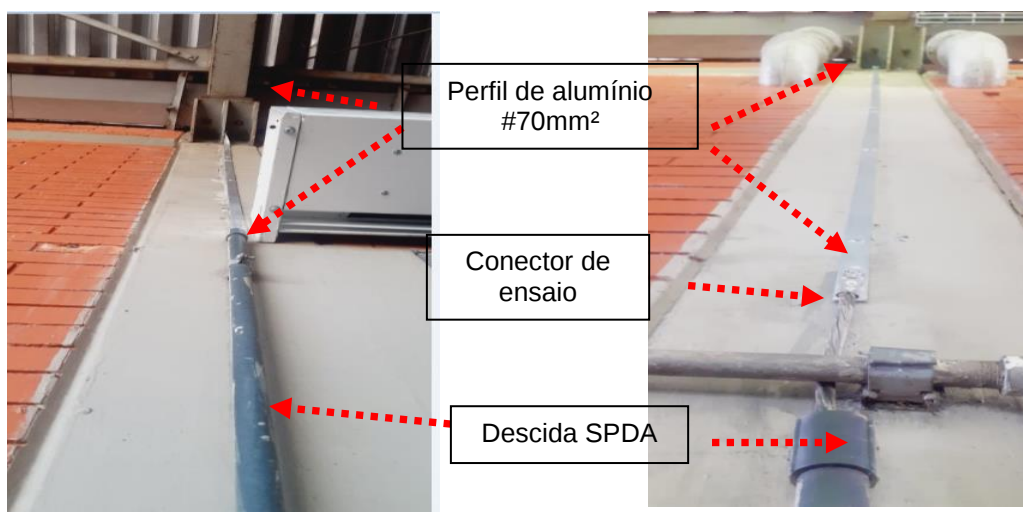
e 126: Implantação de malha captora e terminais sobre a platibanda em alvenaria.
